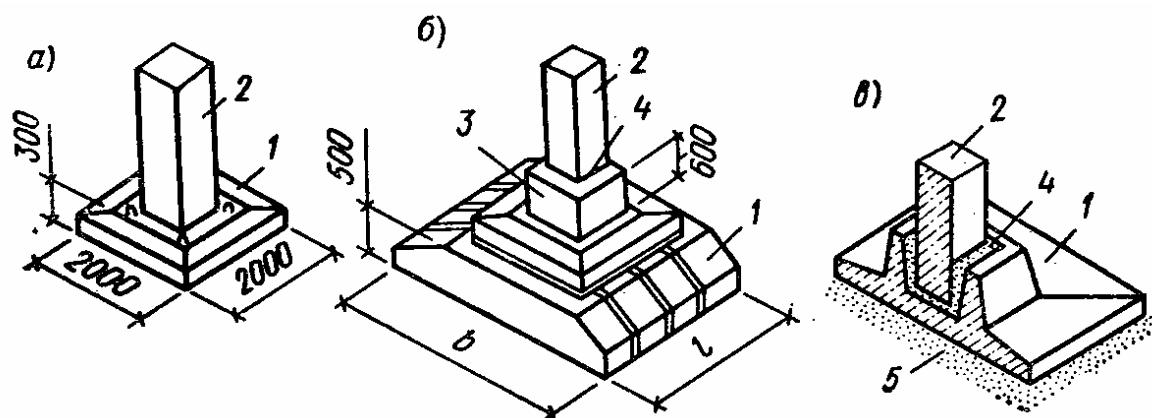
Сборные столбчатые фундаменты многоэтажных зданий:
